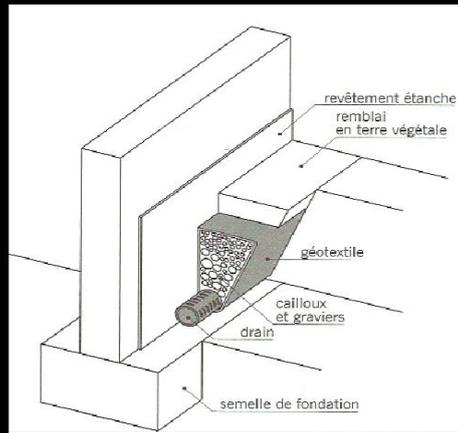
détail d'un drainage extérieur d'un mur de sous-sol
